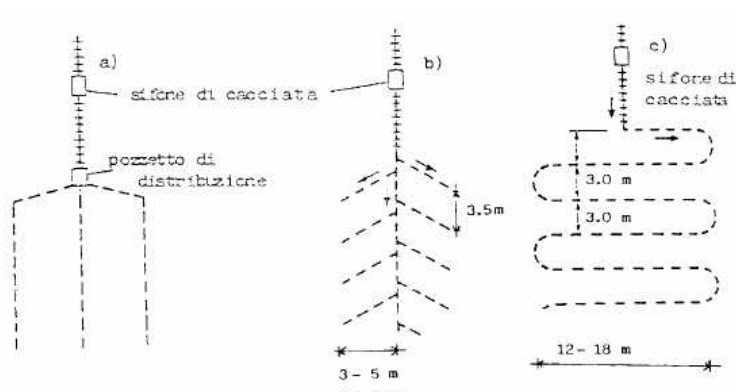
Disposizione delle condotte di sub-irrigazione
